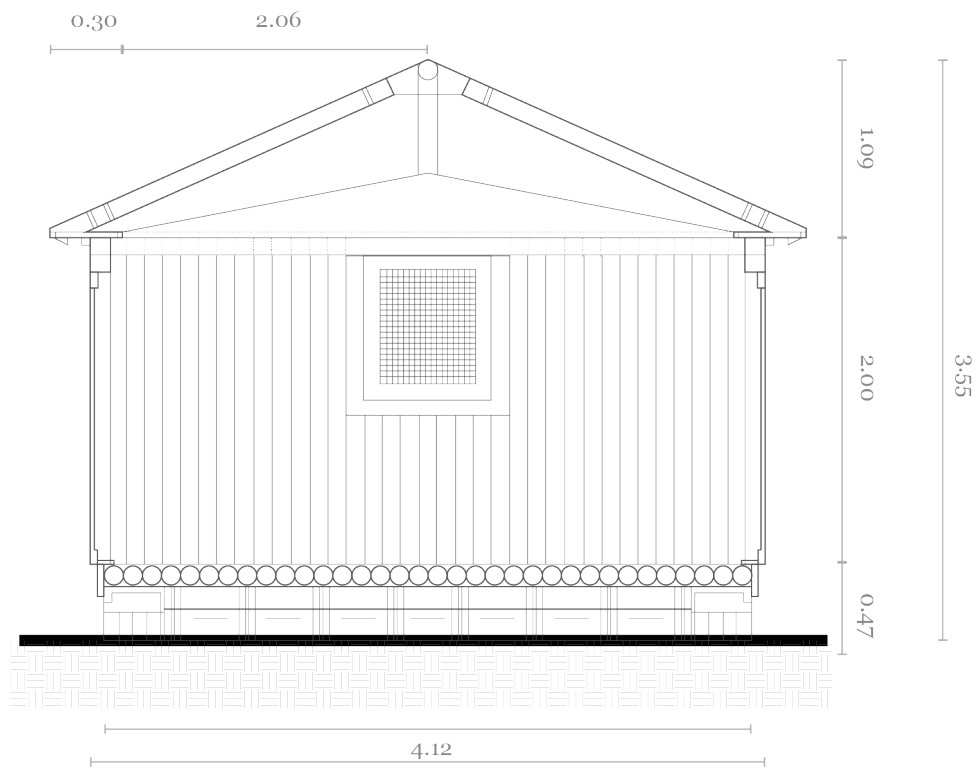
Sección A-A Paper Log House. Elaboración: Autores. Escala 1:50
